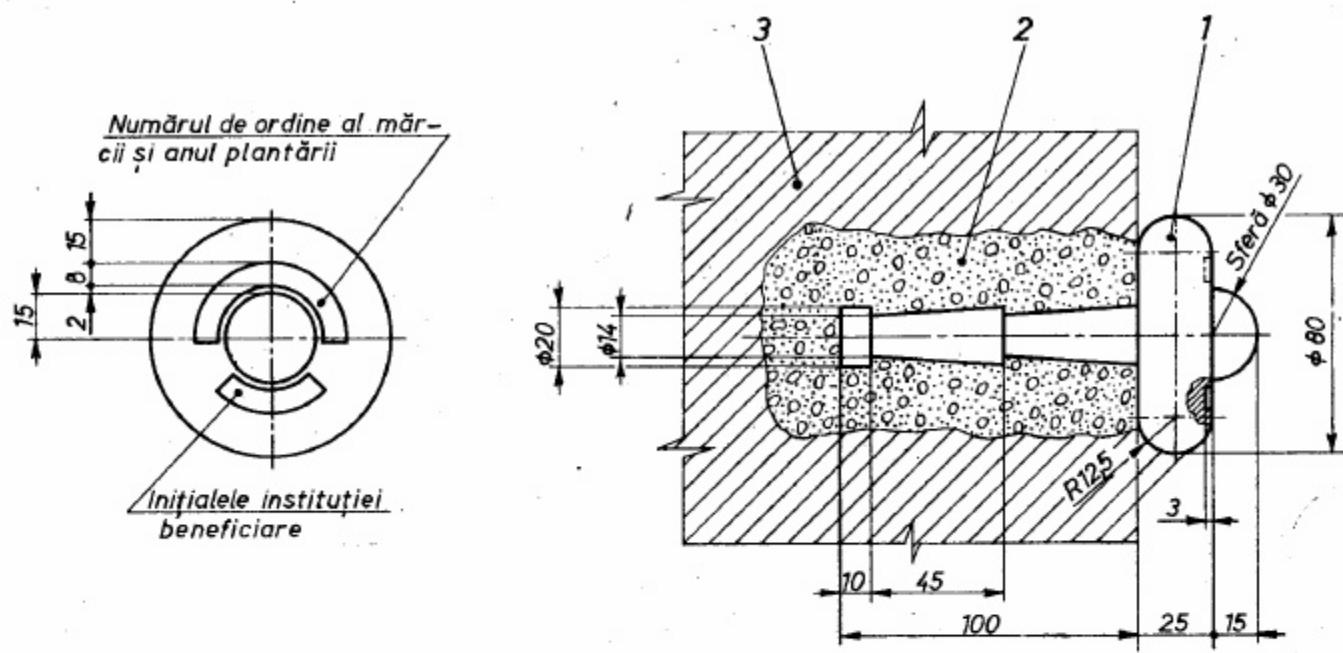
1 — marca de tasare monobloc; 2 — beton simplu; 3 — elementul de construcție
